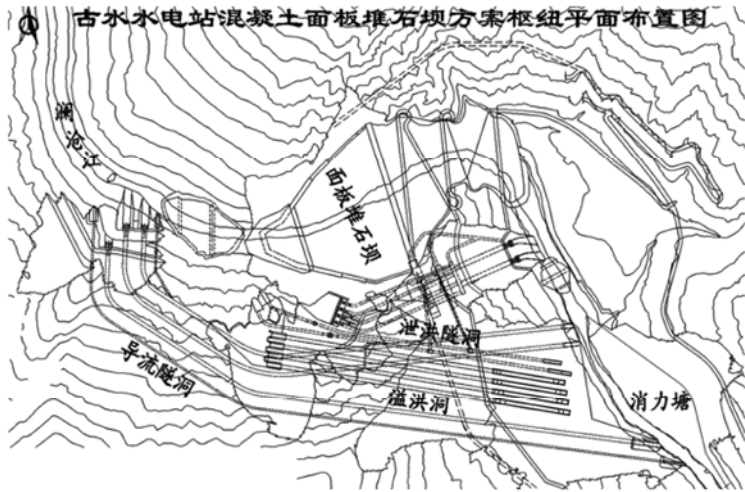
古水水电站面板堆石坝枢纽方案布置示意图
